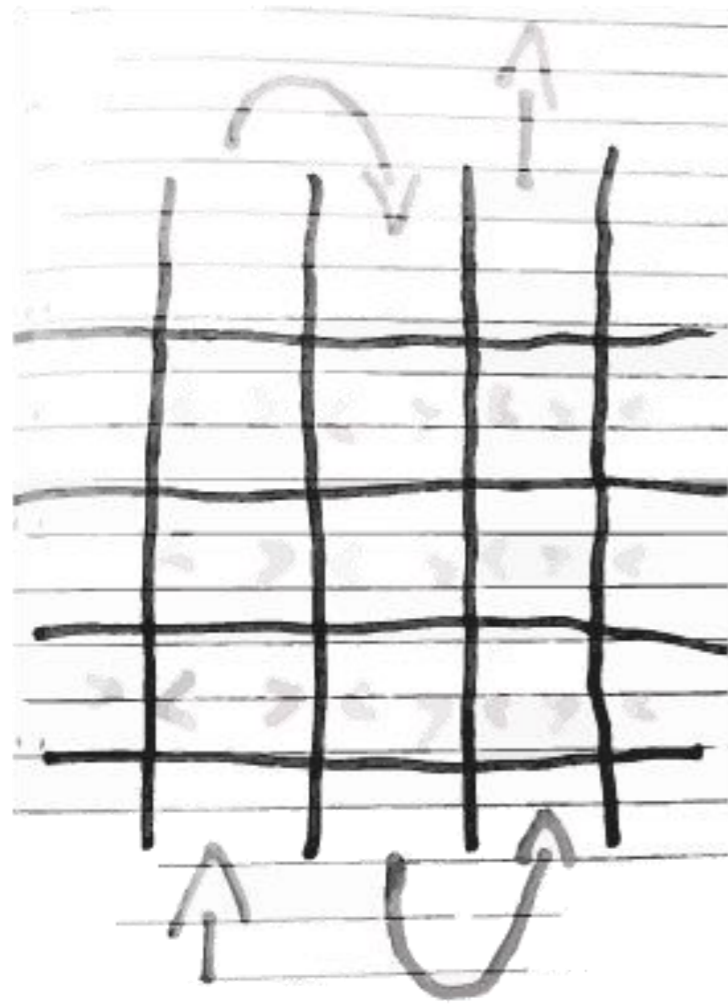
Propuesta del Pabellón aplicado a la inauguración de la ruta de los murales (escalinas Río Tahuando) (Parte 1) Autoría: Propia
